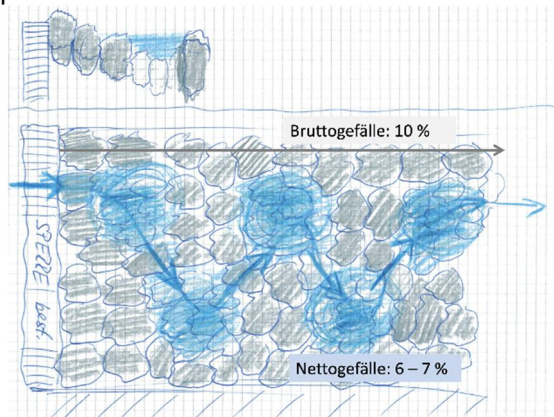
Schemaskizzen der geplanten Blockrampe mit Beckenstruktur
